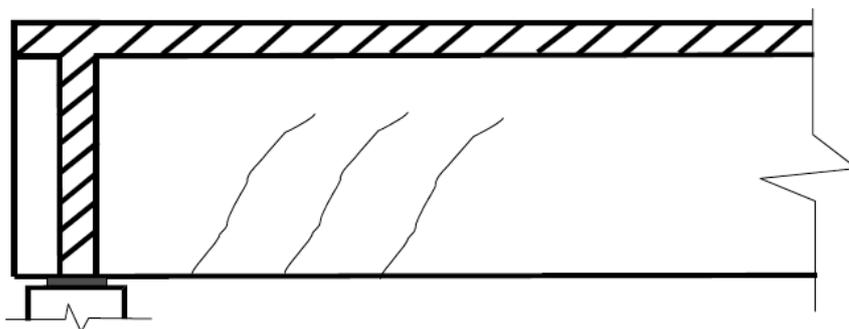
Configuração da fissuração por efeito de cisalhamento
